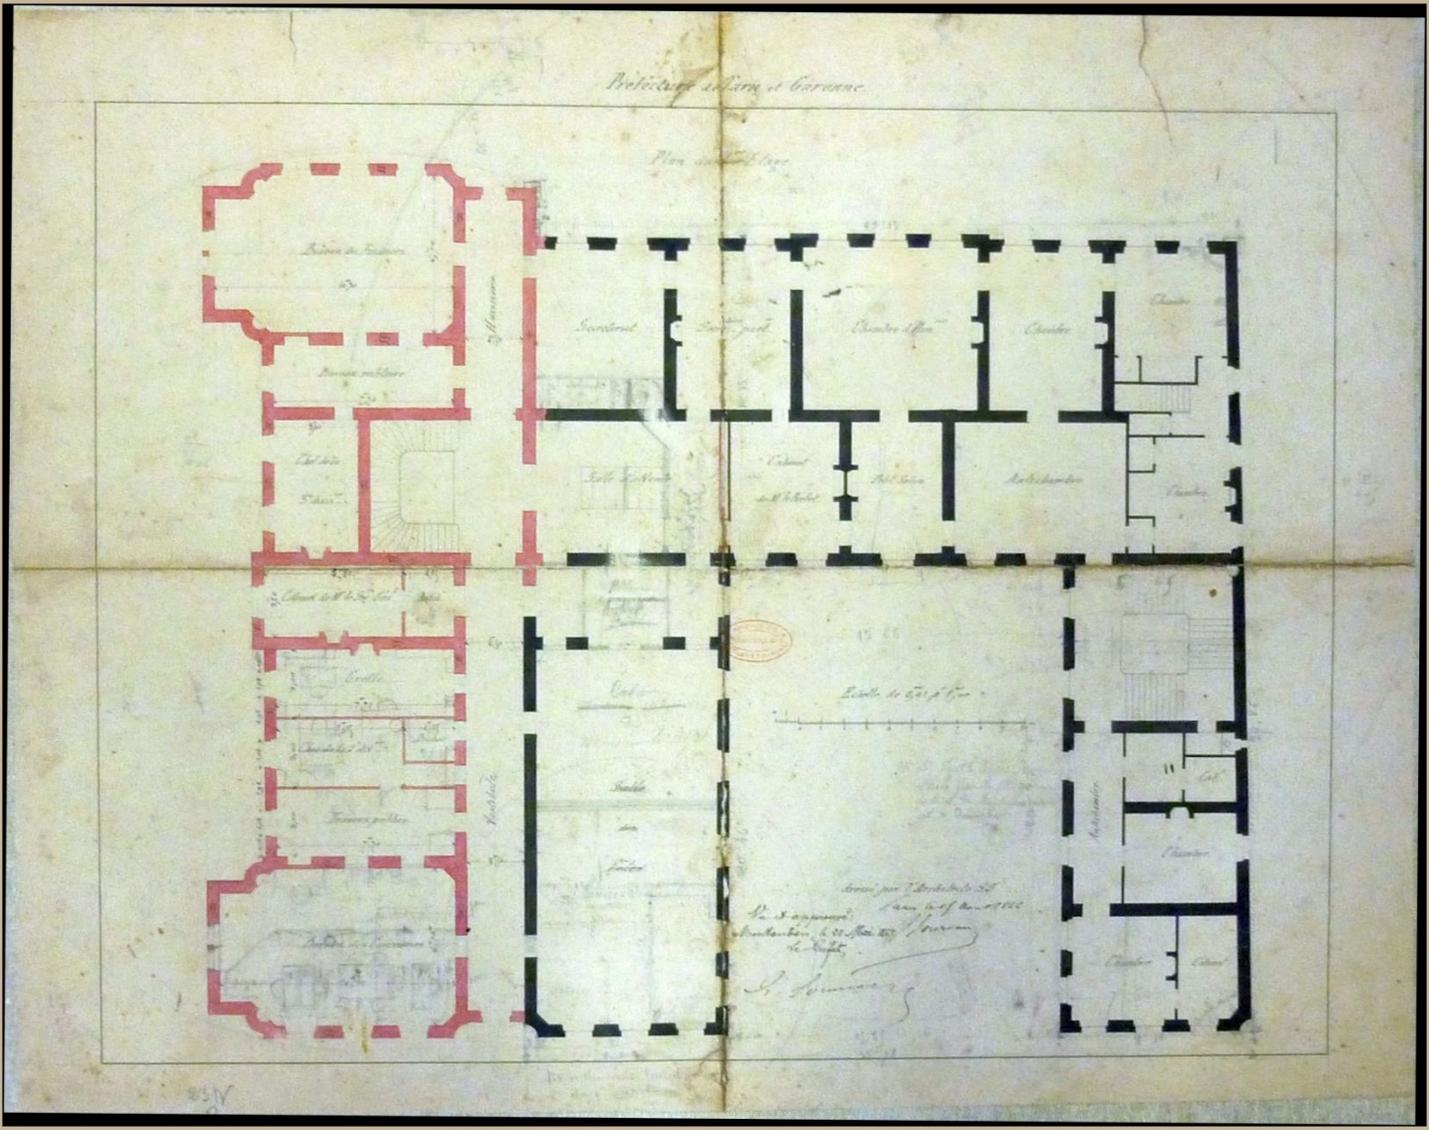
J. Bourdais, Plan du 1er étage, 15 août 1866
